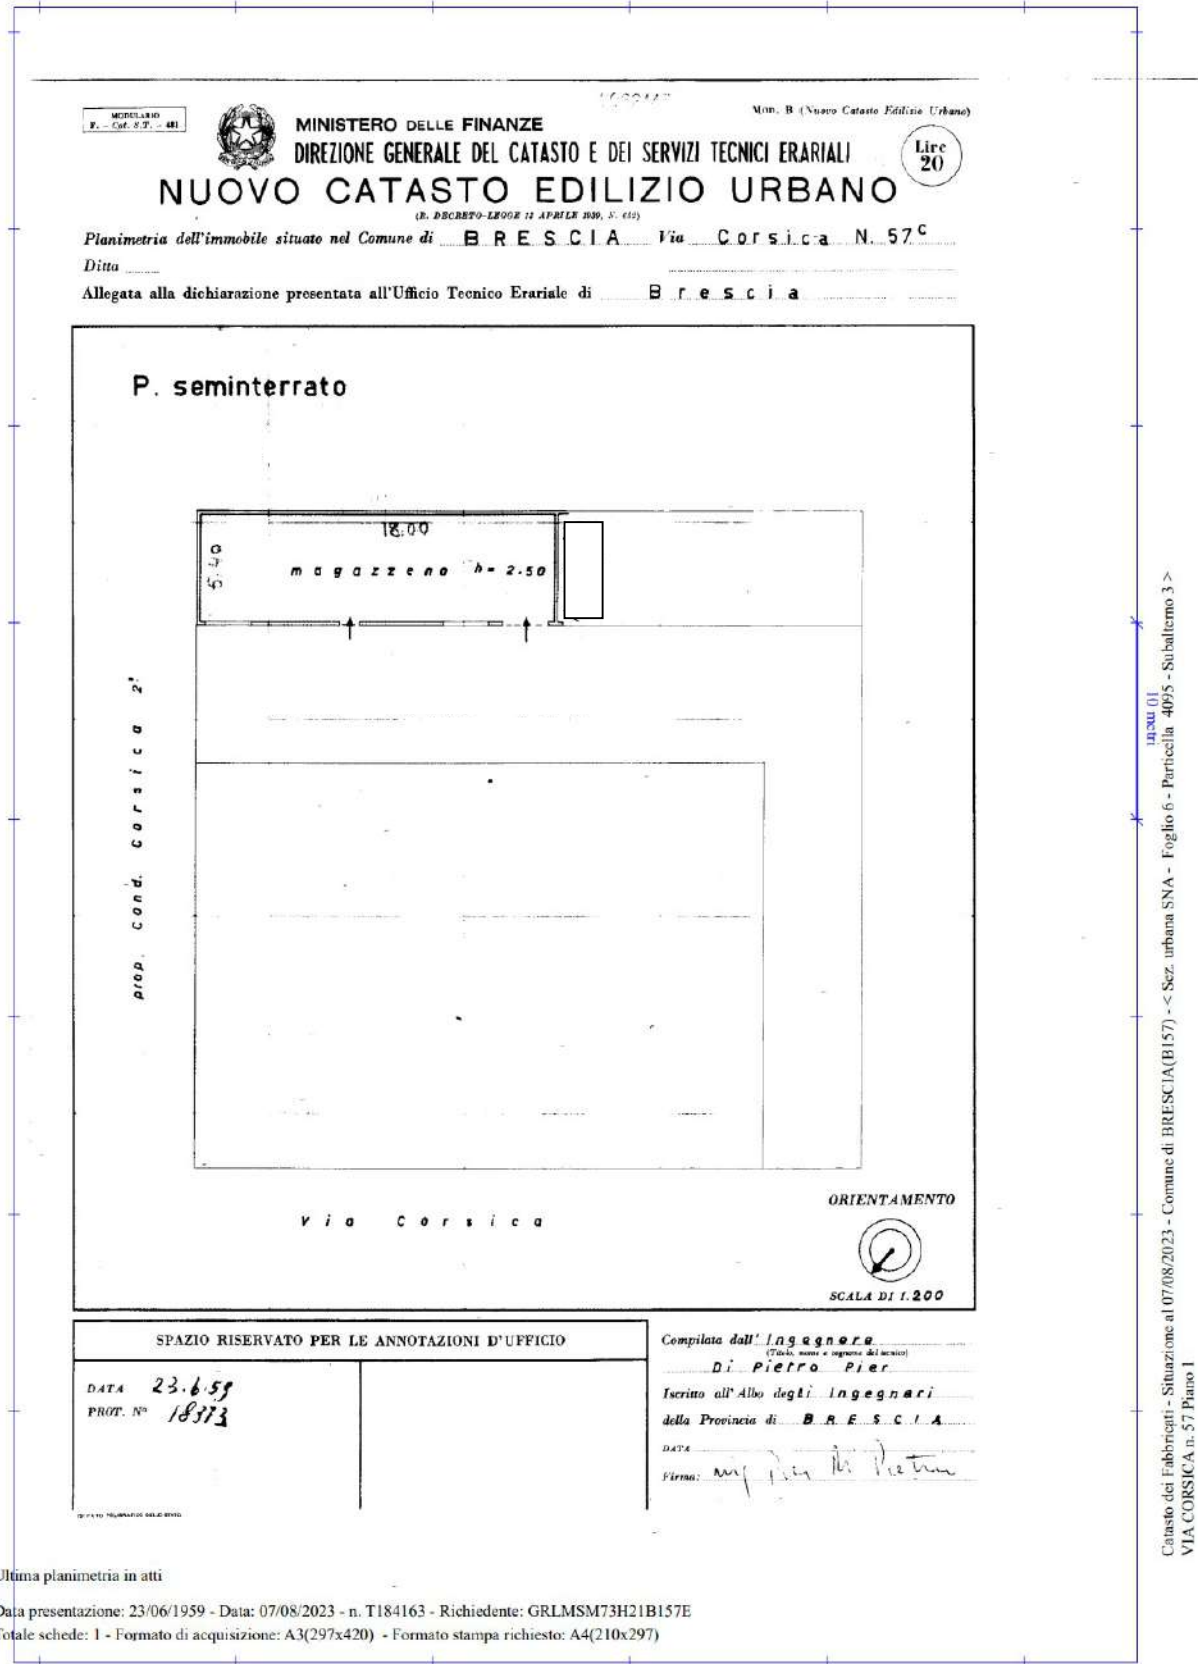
Estratto planimetria – Sez. SNA fg.6 Part. 4095 sub 3
